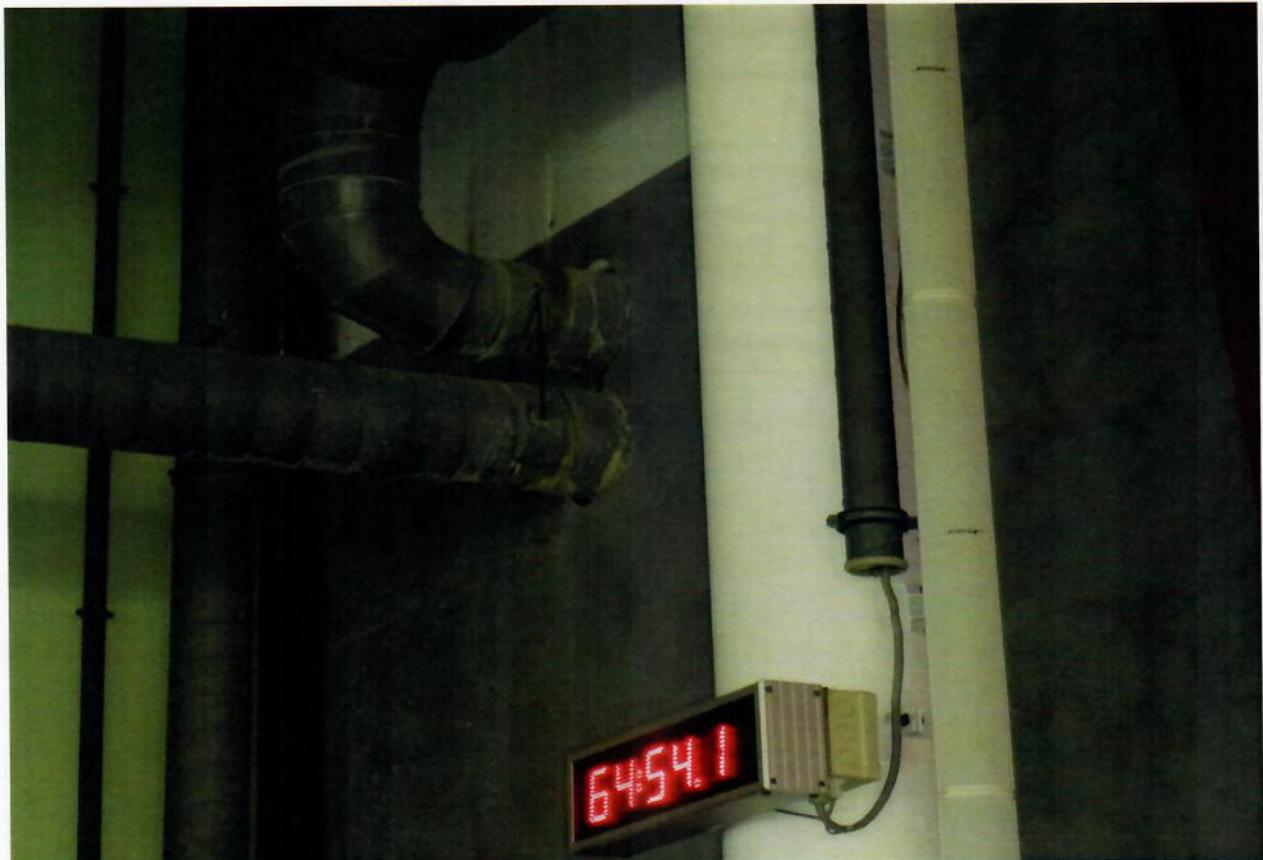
Lüftung 11: Lüftungsleitungen im Bereich Ausgang L2
